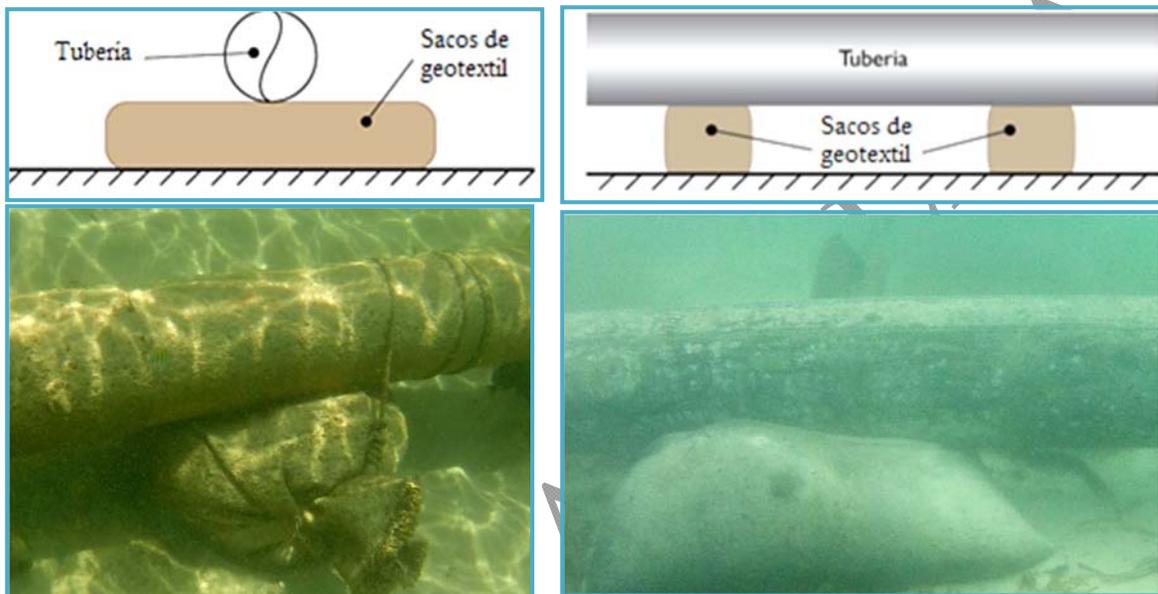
Tuberías y mangueras con lastre de proyectos similares.
